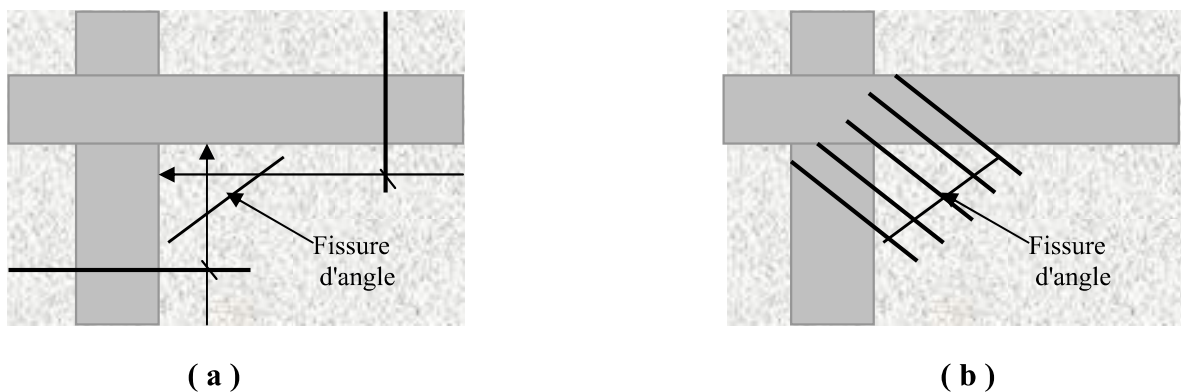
Fissuration à 45° d'une dalle ; dispositions préventives du ferrailage:
